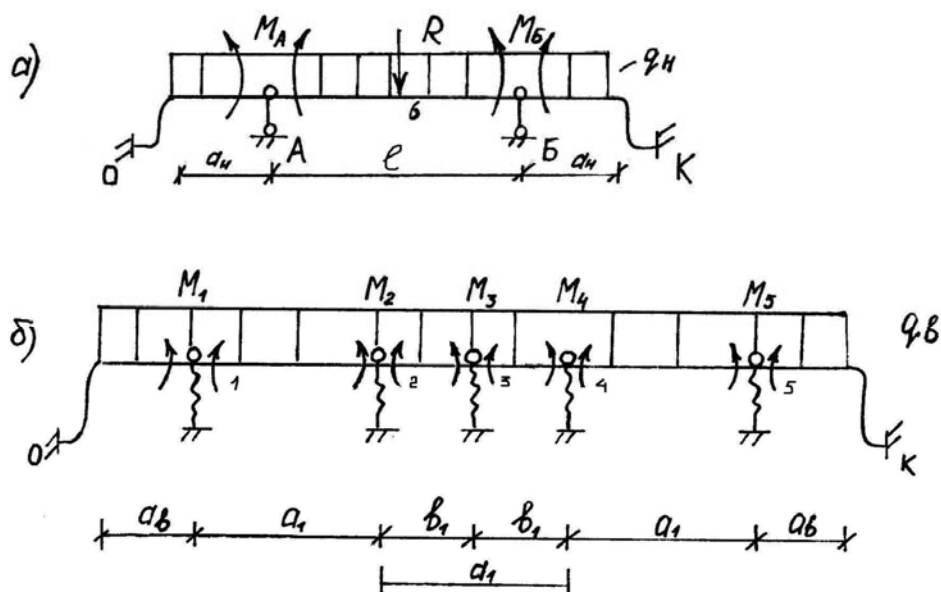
Расчетная схема двухъярусной балочной трубчатой конструкции:
